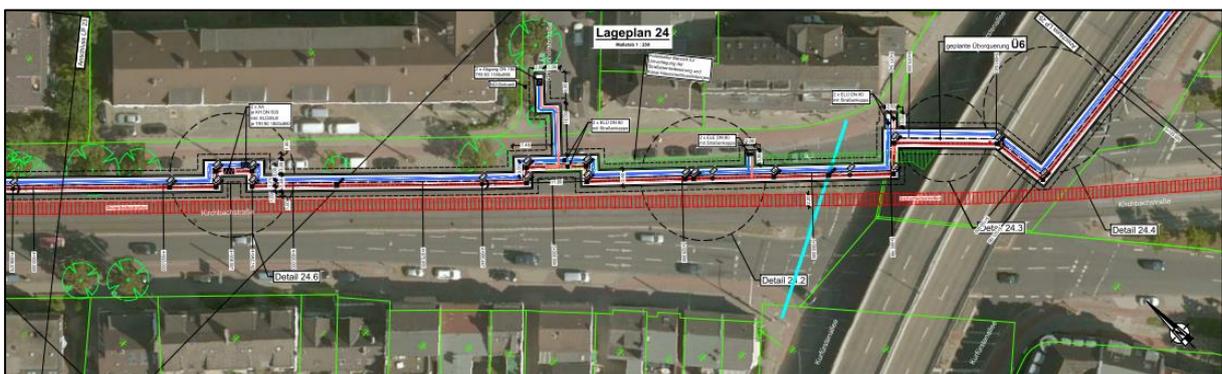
Abschnitt 13/14 - Kirchbachstraße / Kurfürstenallee Plan 2.2.24
